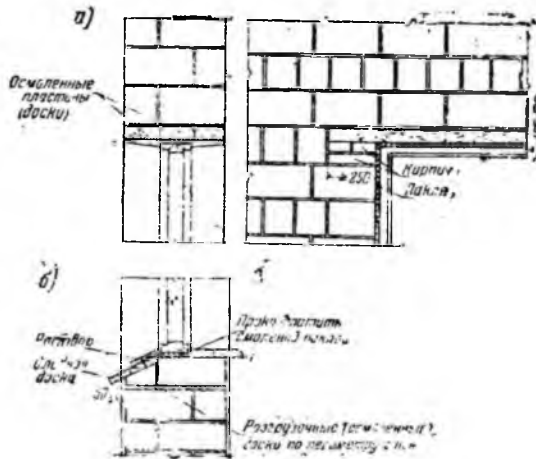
Перекрышки и отливки в грунтоблочных стенах
